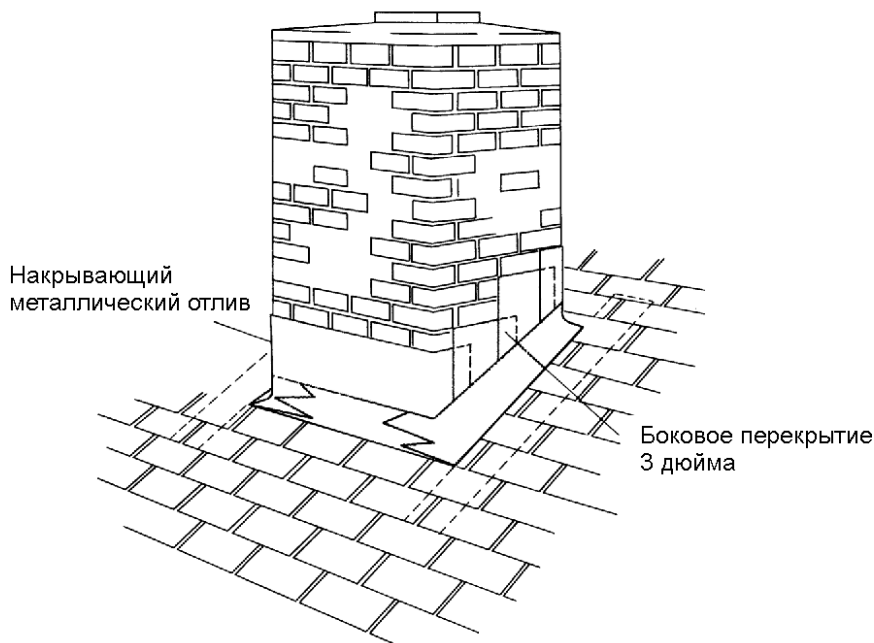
Металлический верхний отлив, закрывающий основную гидроизоляцию (Bird and Son)
